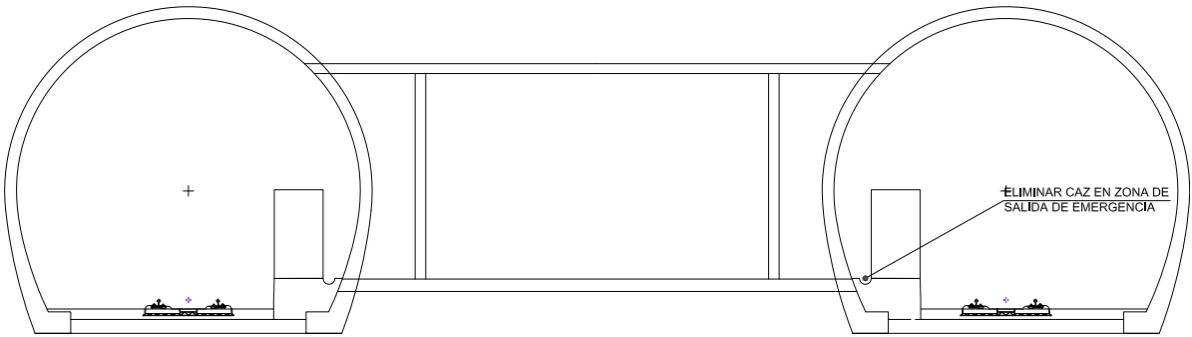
Galería de conexión túnel bitubo Fuente: NAP 2-3-1.0_ED2 Túneles (2ª Edición: Enero 2023)
